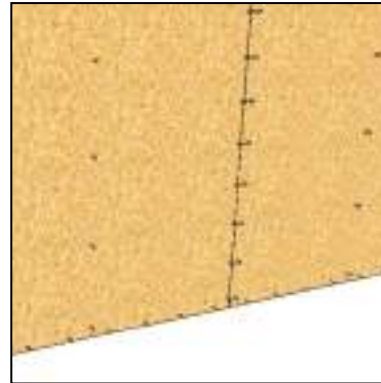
Vue d'un panneau de mur structurel LogiWall
